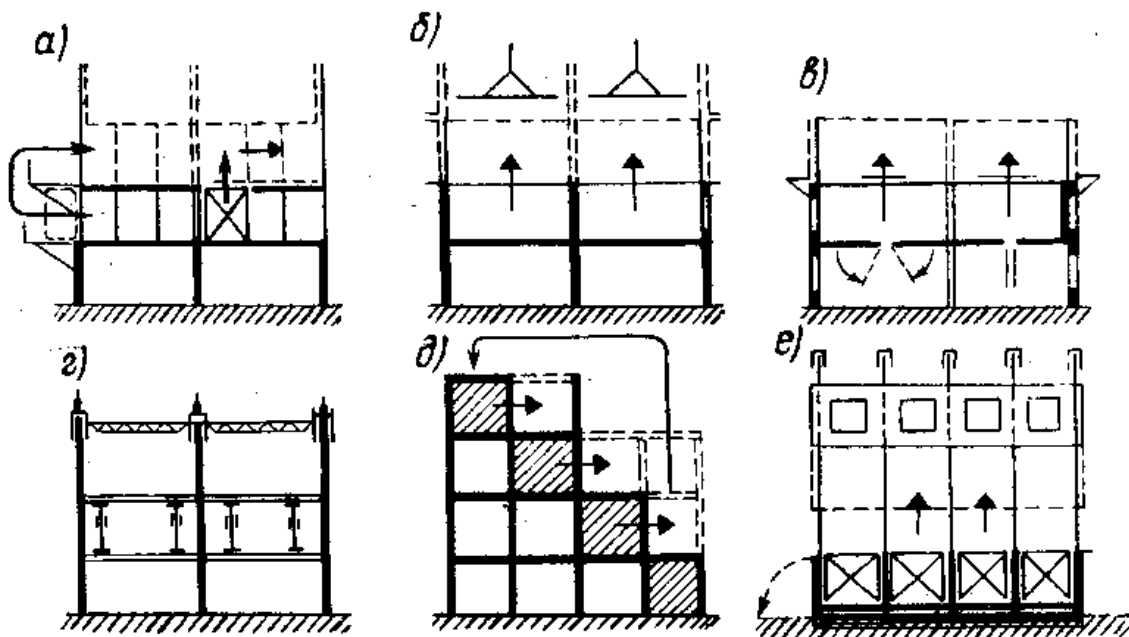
Схеми зведення монолітних будівель:
